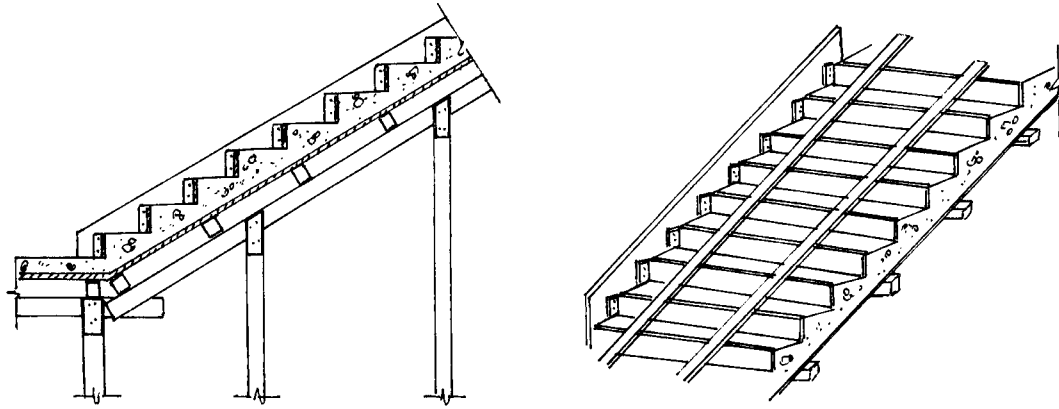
Detalhes do escoramento e da fôrma de uma escada
